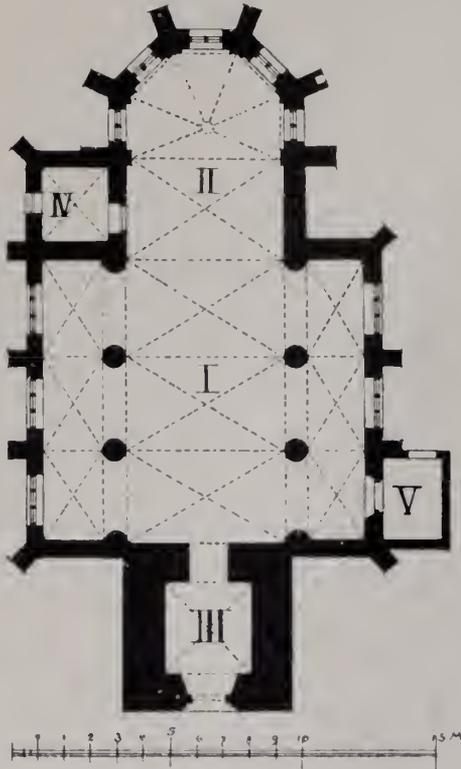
Amern S. Anton. Grundriss der Pfarrkirche.
